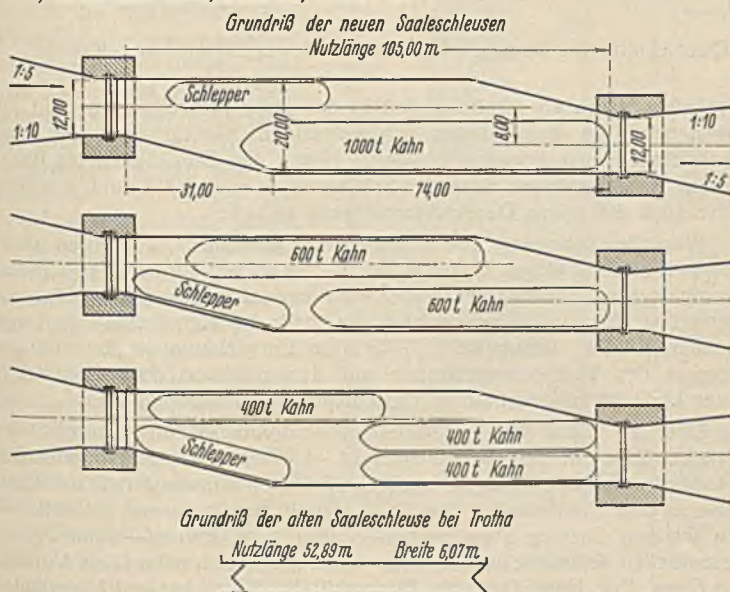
Grundriß der neuen Saaleschleusen und einer alten Schleuse.
